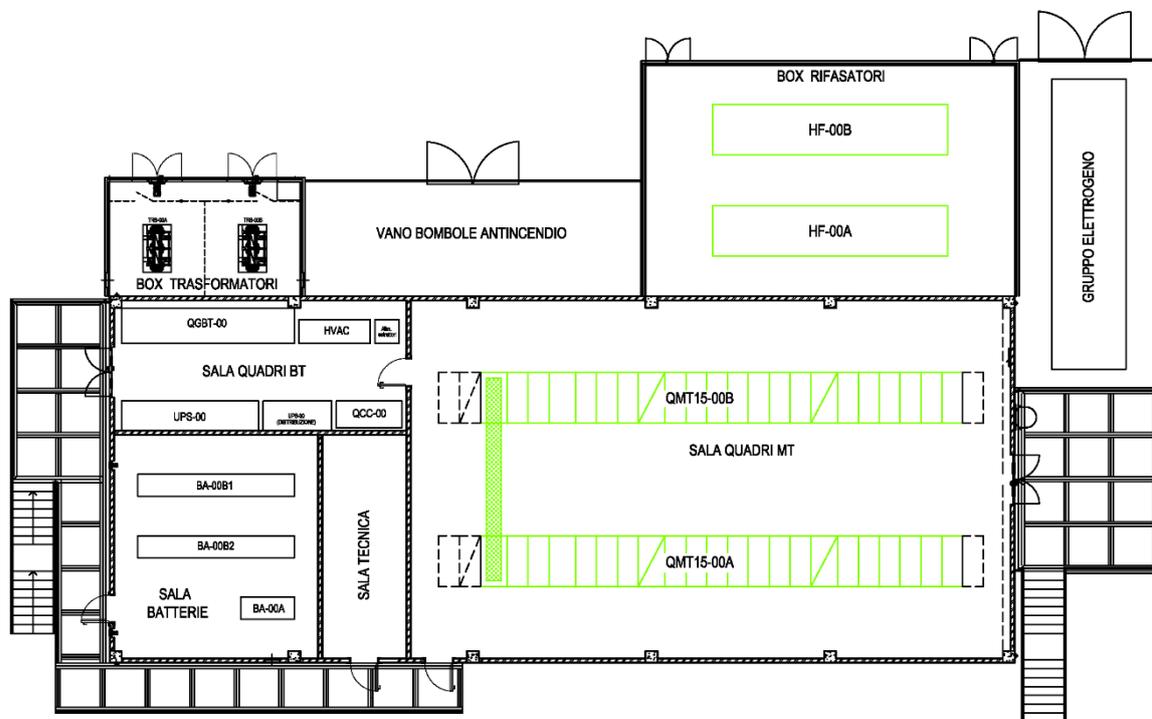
Cabina elettrica LSCT Ravano – Layout apparecchiature (21\_08\_PE\_TP04)
